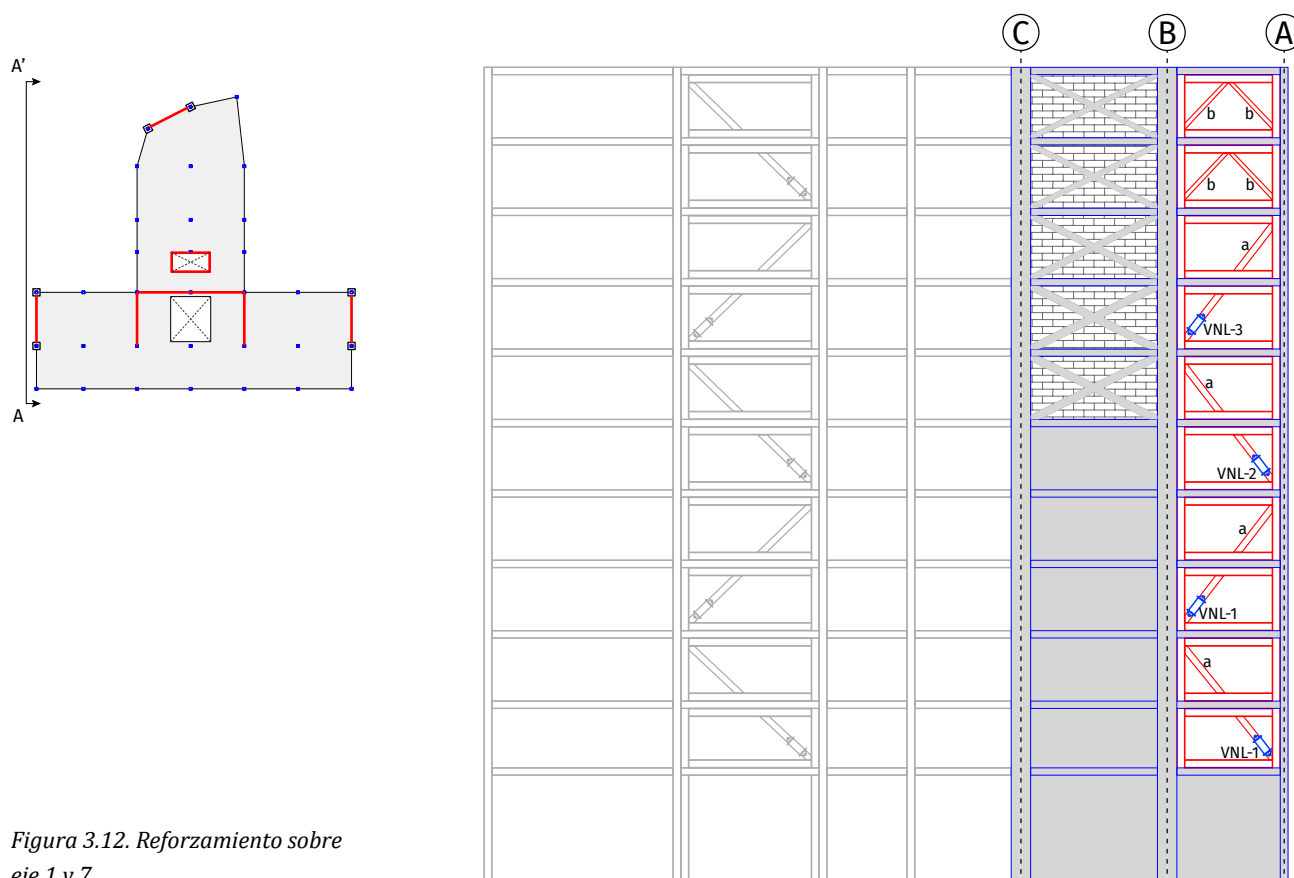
Reforzamiento sobre eje 1 y 7.
